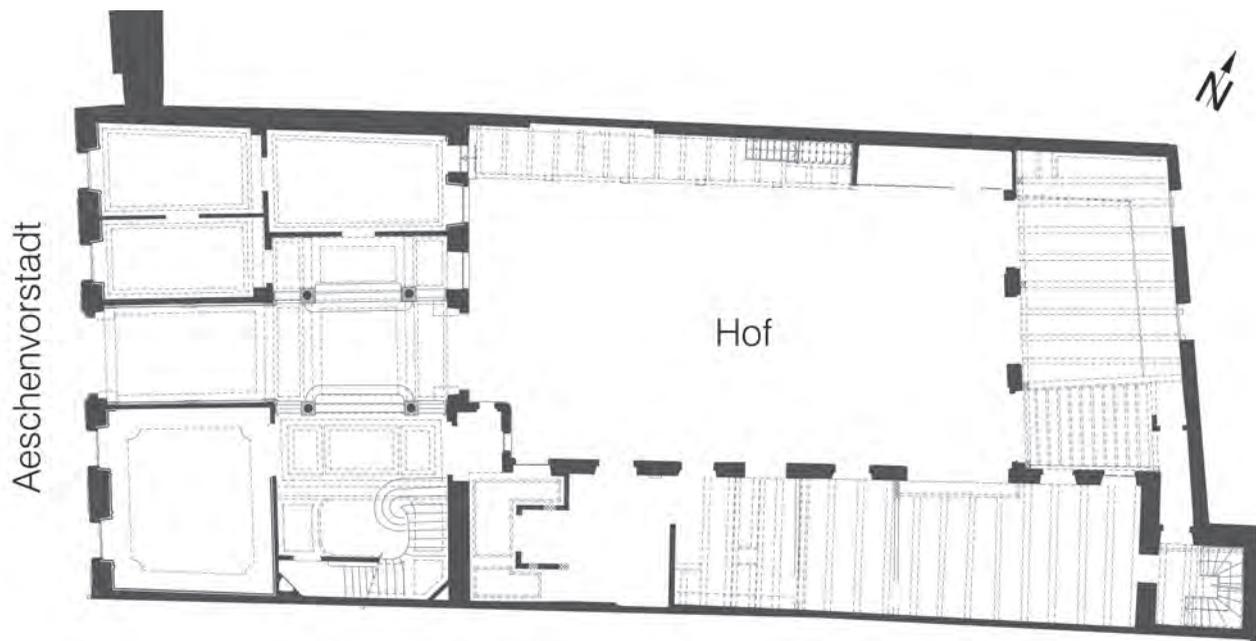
Aeschenvorstadt 13. Parzellengrundriss. – Bearbeitung: Hans Ritzmann. Grundlage: Projektplan von Büro Villa Nova.
